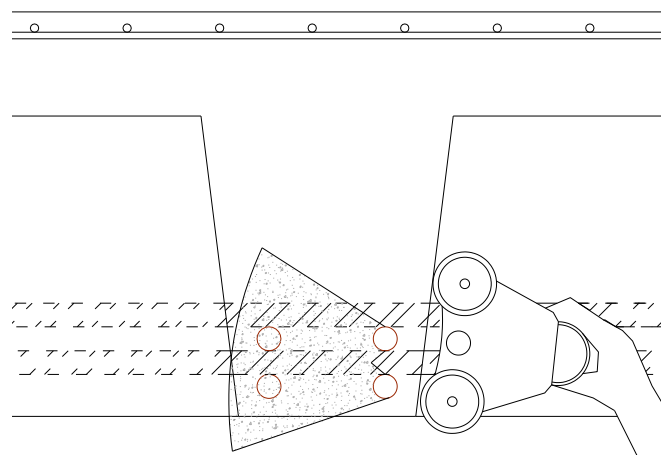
Corte CD – Ensaio Ferroskan na face lateral.
